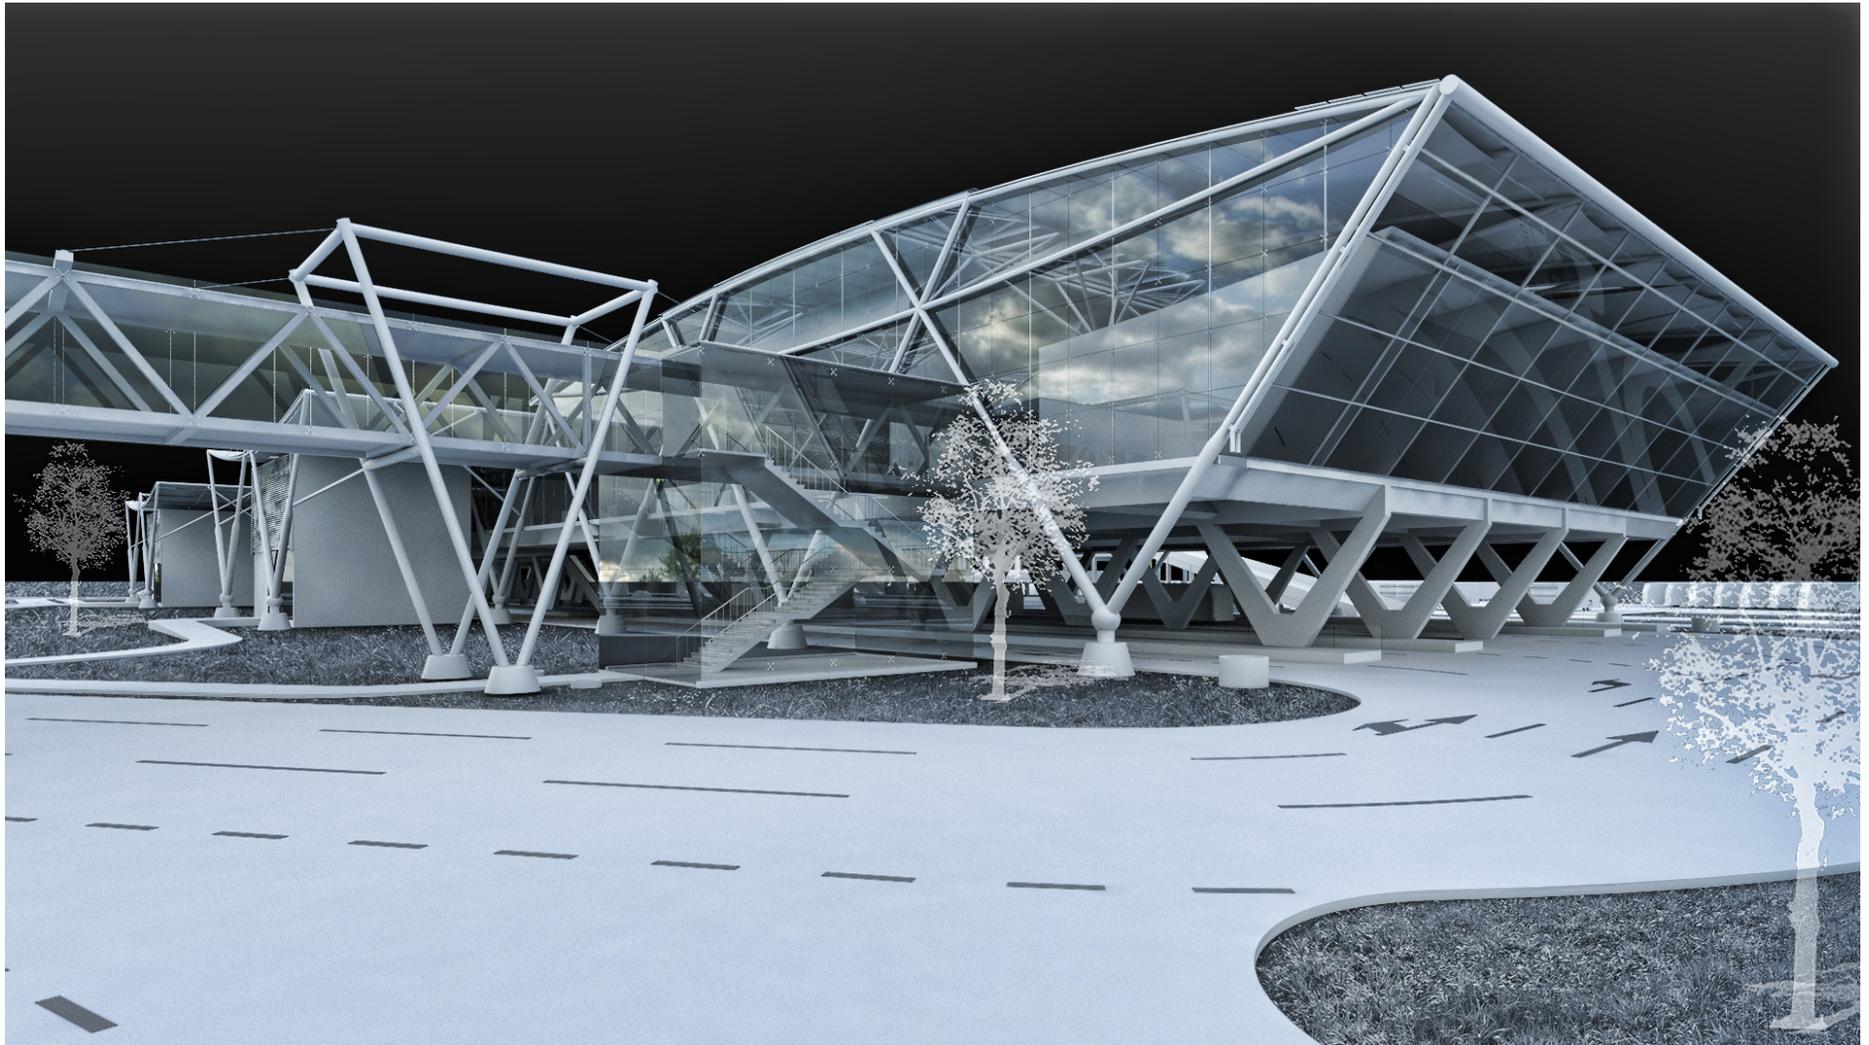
Vista desde el noroeste. Autoría propia. 2015.
